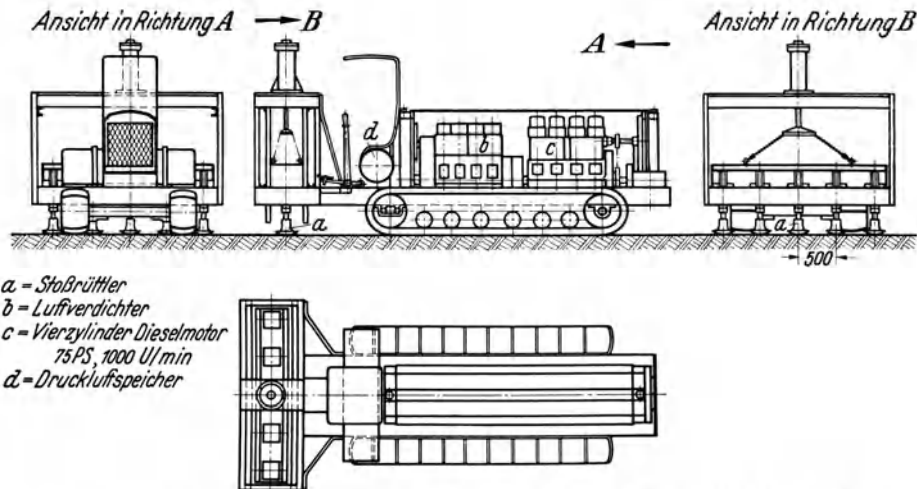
Raupenfahrbare Dammverdichtungsanlage Bauart Döring (Frankfurter Maschinenbau A. G.).
